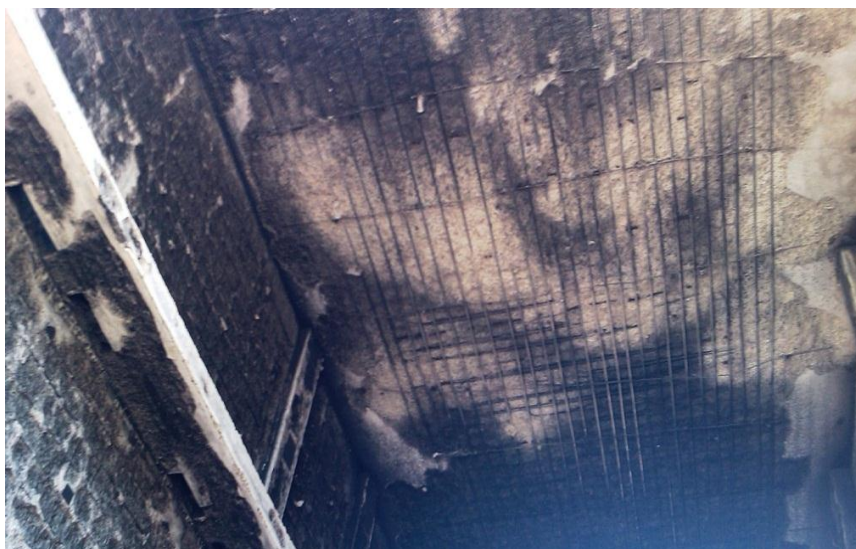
Разрушение монолитного железобетона на перекрытии дворового проезда
